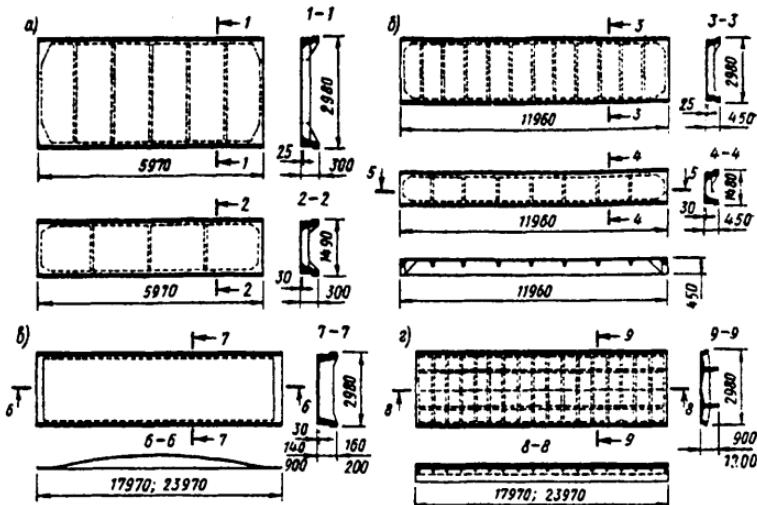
Крупноразмерные железобетонные плиты покрытий:
